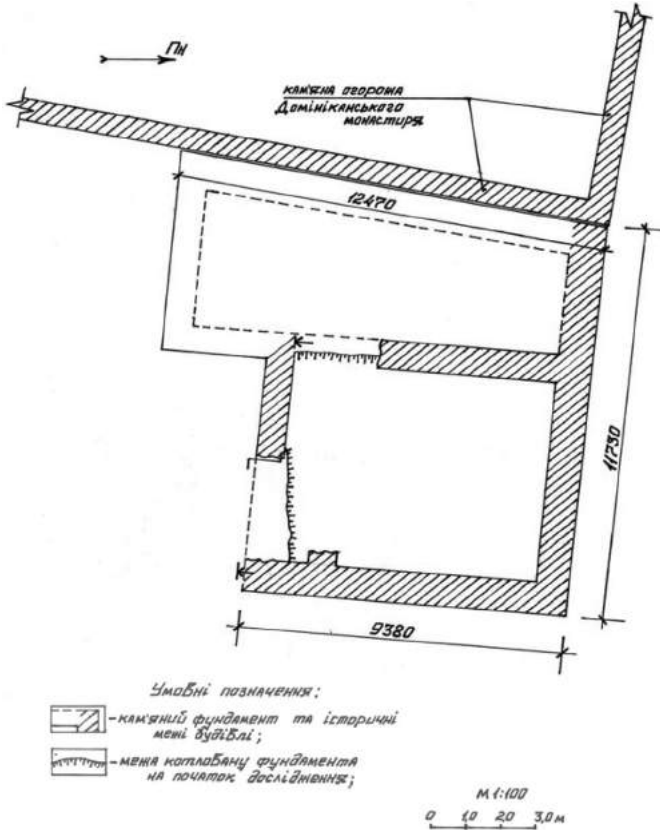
Схема-план фундаменту будинку по вул. П'ятницька, 10
